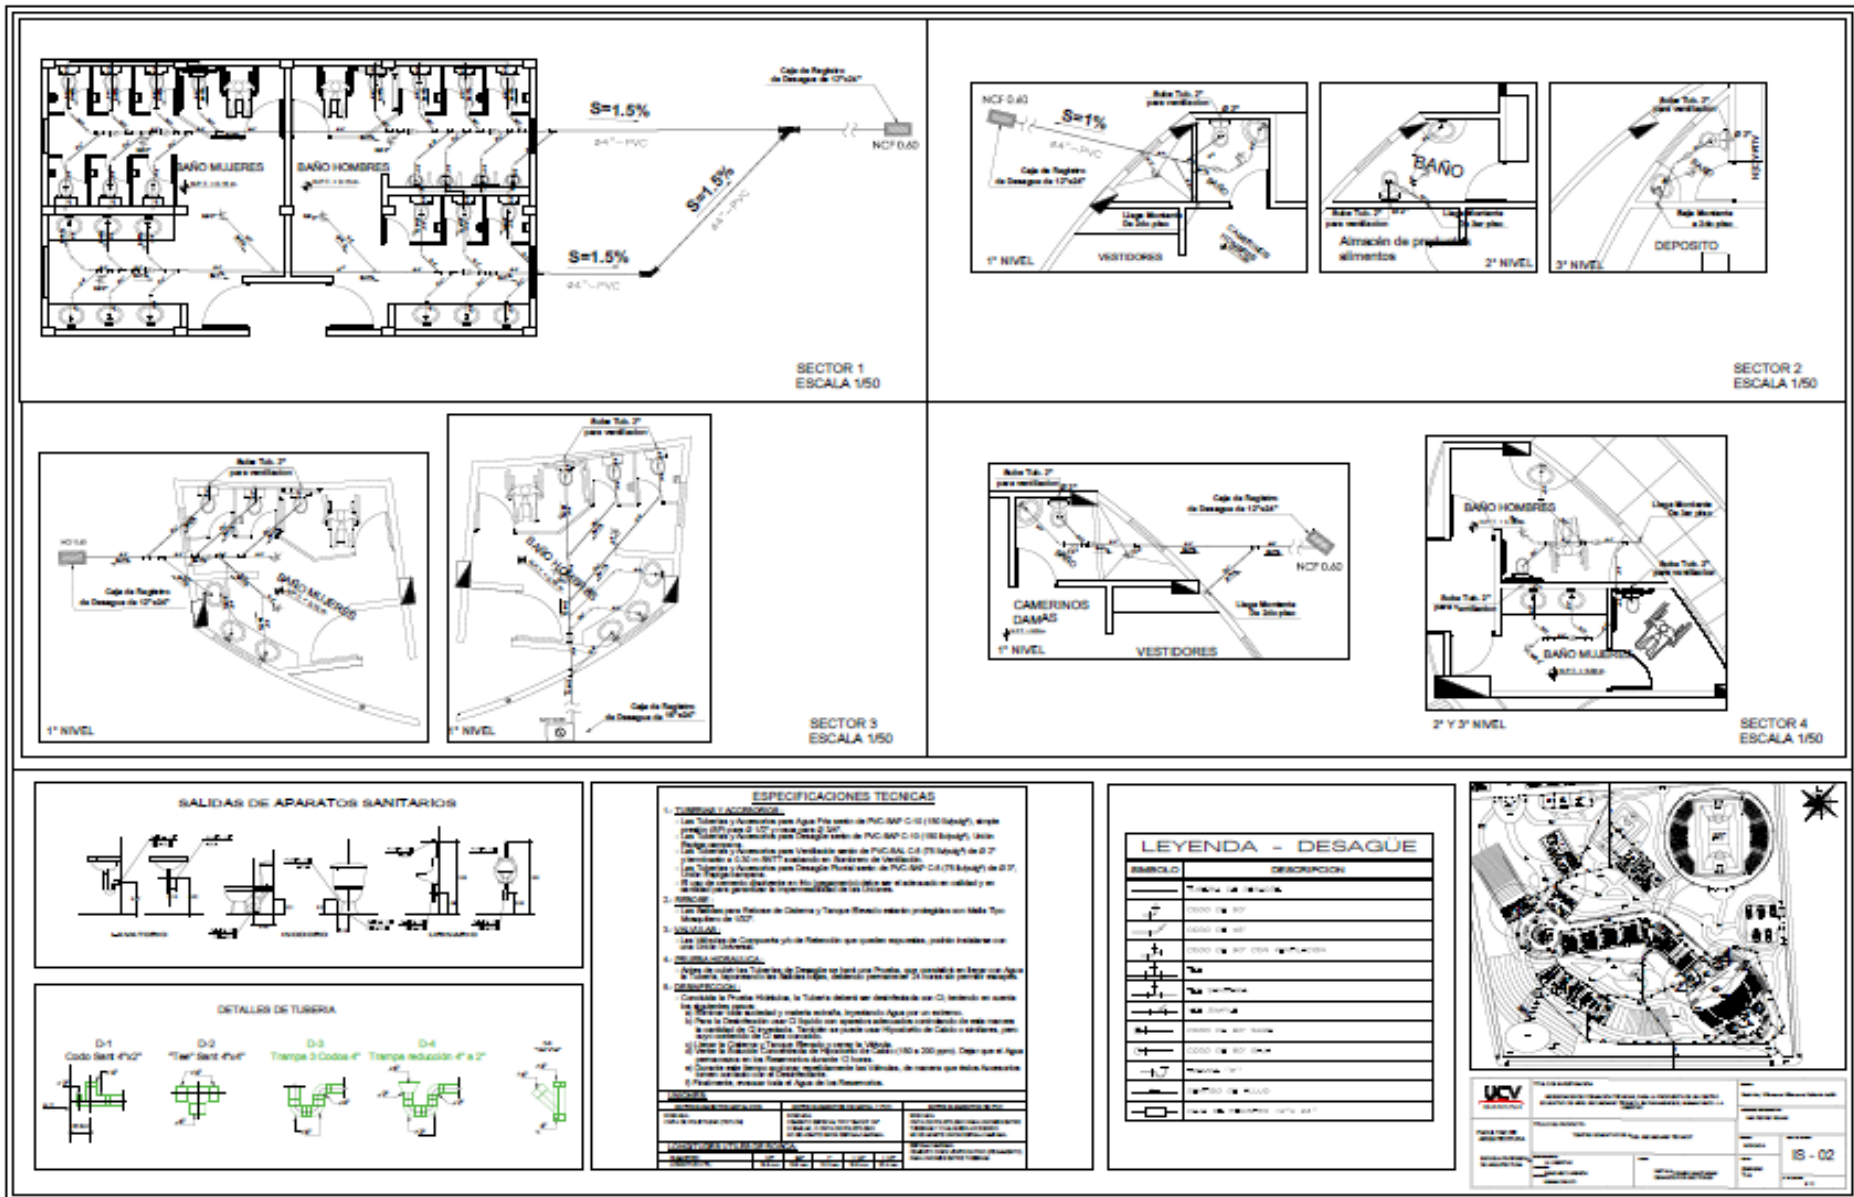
Plano de Diseño de Instalaciones Básicas Bloque 01 – Desagüe - Plano N° 22 - Lamina IS-02
